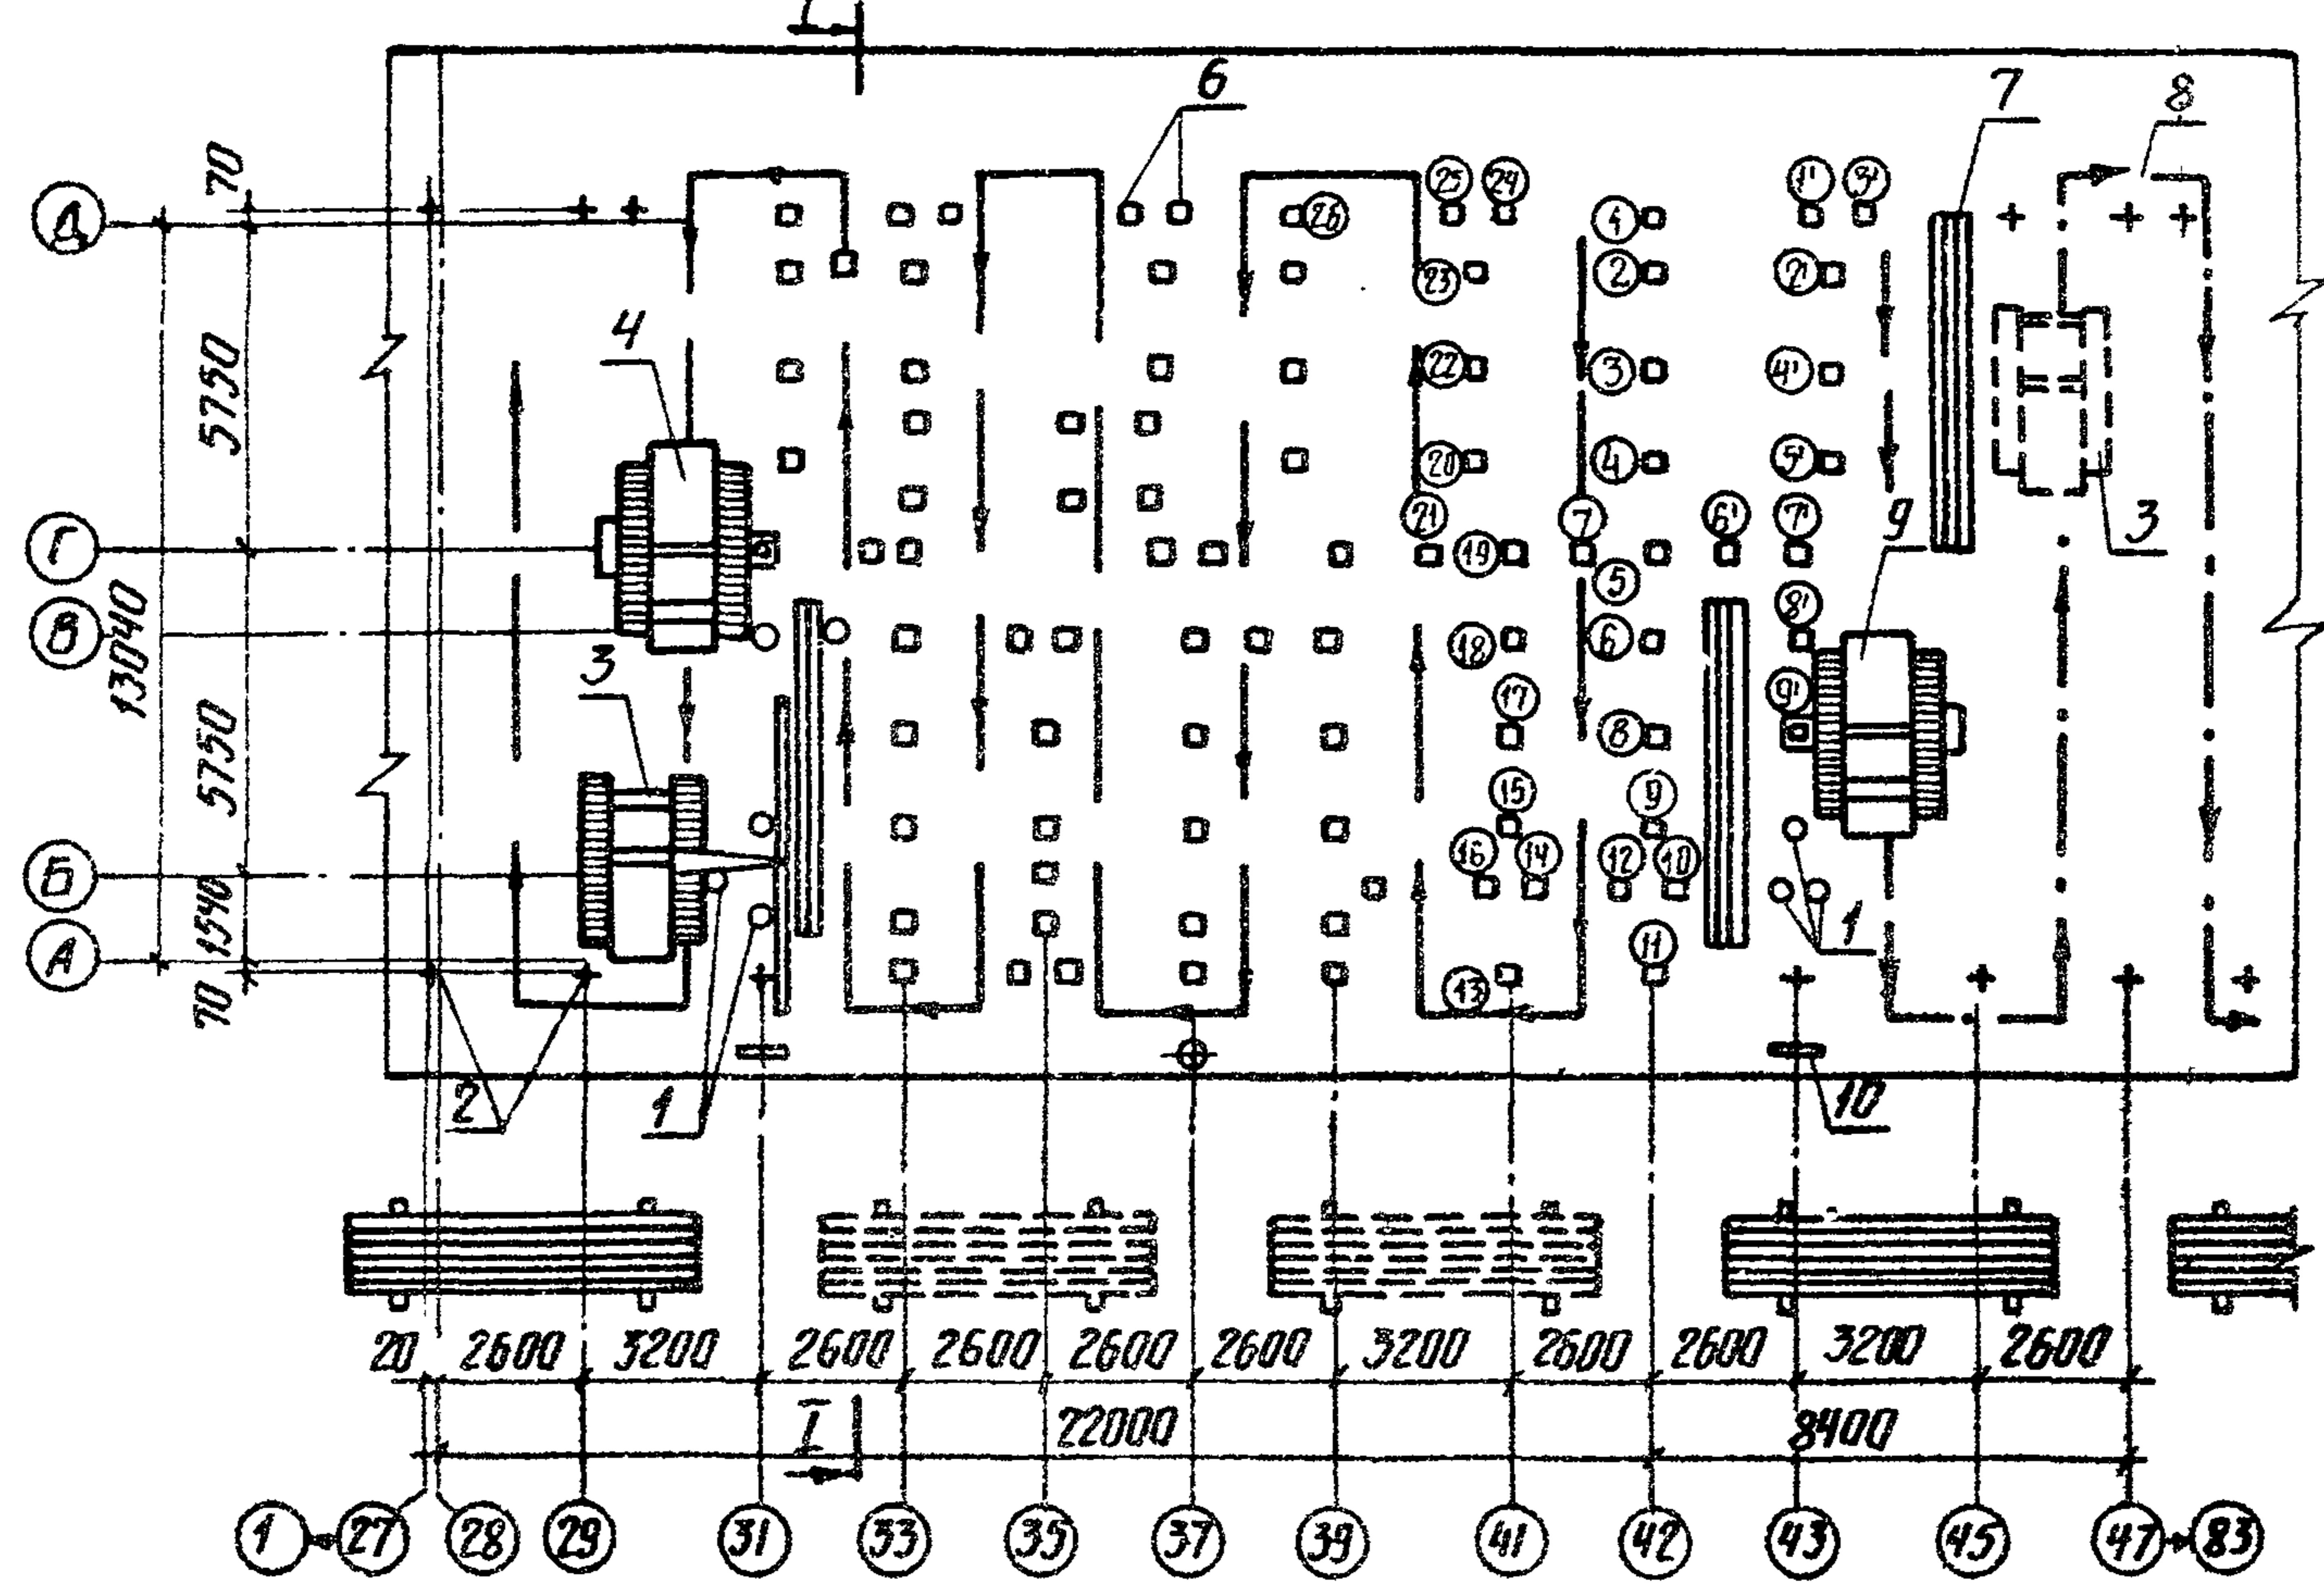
Схема забивки свай: 1-места расположения свай; 2-места расположения свай на главных осях; 3-трубоукладчик ТД-Т-75; 4-сваебойный агрегат С-878М № 1; 5-направление движения агрегата № 1; 6-забитые сваи; 7-разложенные сваи; 8-направление движения агрегата № 2; 9-сваебойный агрегат С-878М № 2; 10-переносные визирки; 1 2 3 - последовательность забивки свай агрегатом № 1; 11 12 13 - последовательность забивки свай агрегатом № 2
